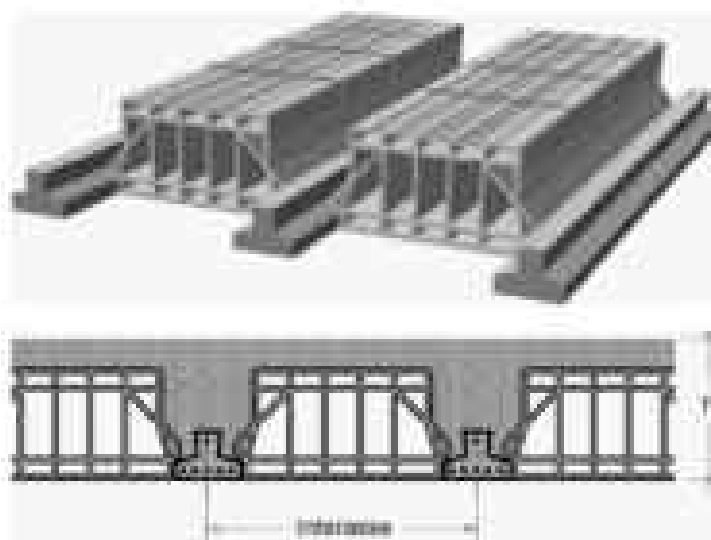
Esempio di solaio in cemento armato a travetti in cemento armato e blocchi interposti
